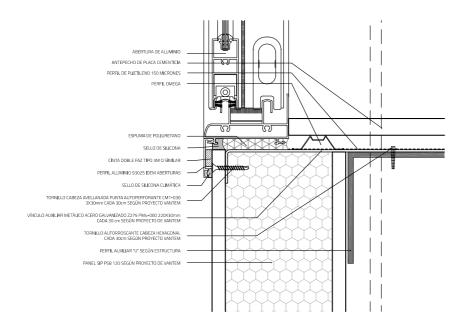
DETALLE 4: FIJACIÓN DE PANELES A ANTEPECHO.
